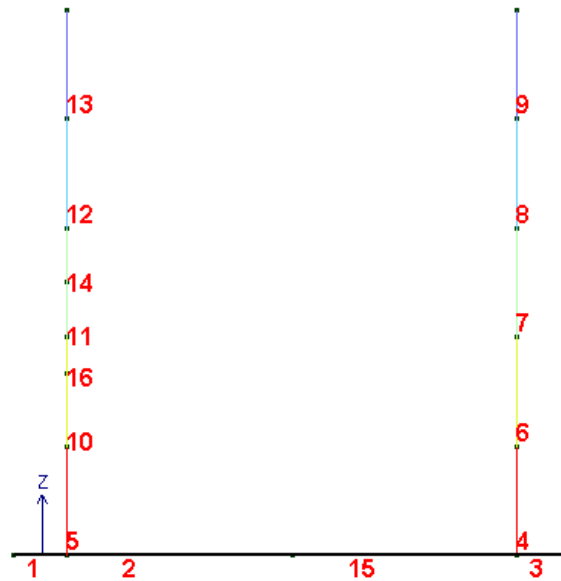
Modellazione muro ad “U”: numerazione elementi D2
